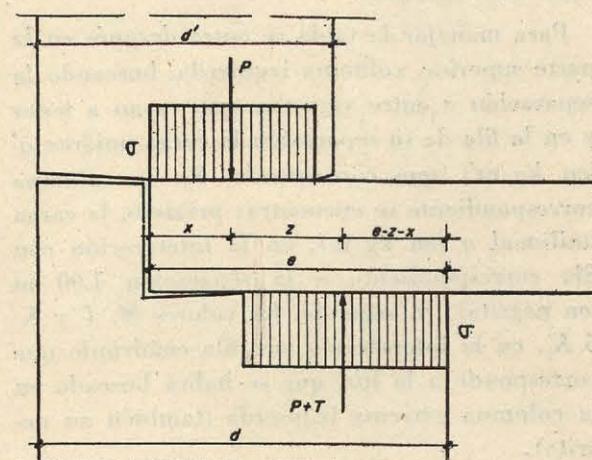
Hipótesis para el cálculo de las tensiones en un muro con viguetas empotradas.
